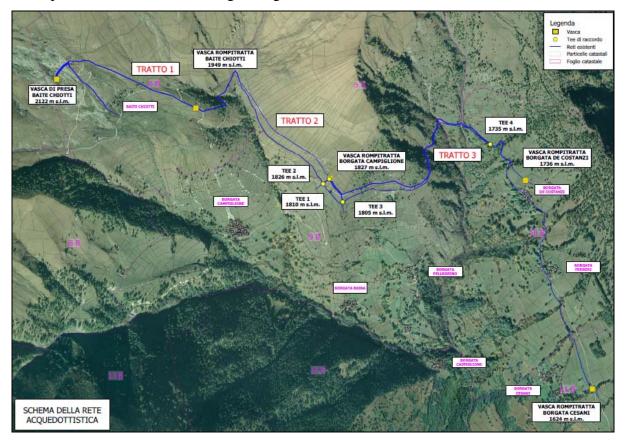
Estratto planimetrico con indicazione della rete acquedottistica esistente e delle Borgate servite.
